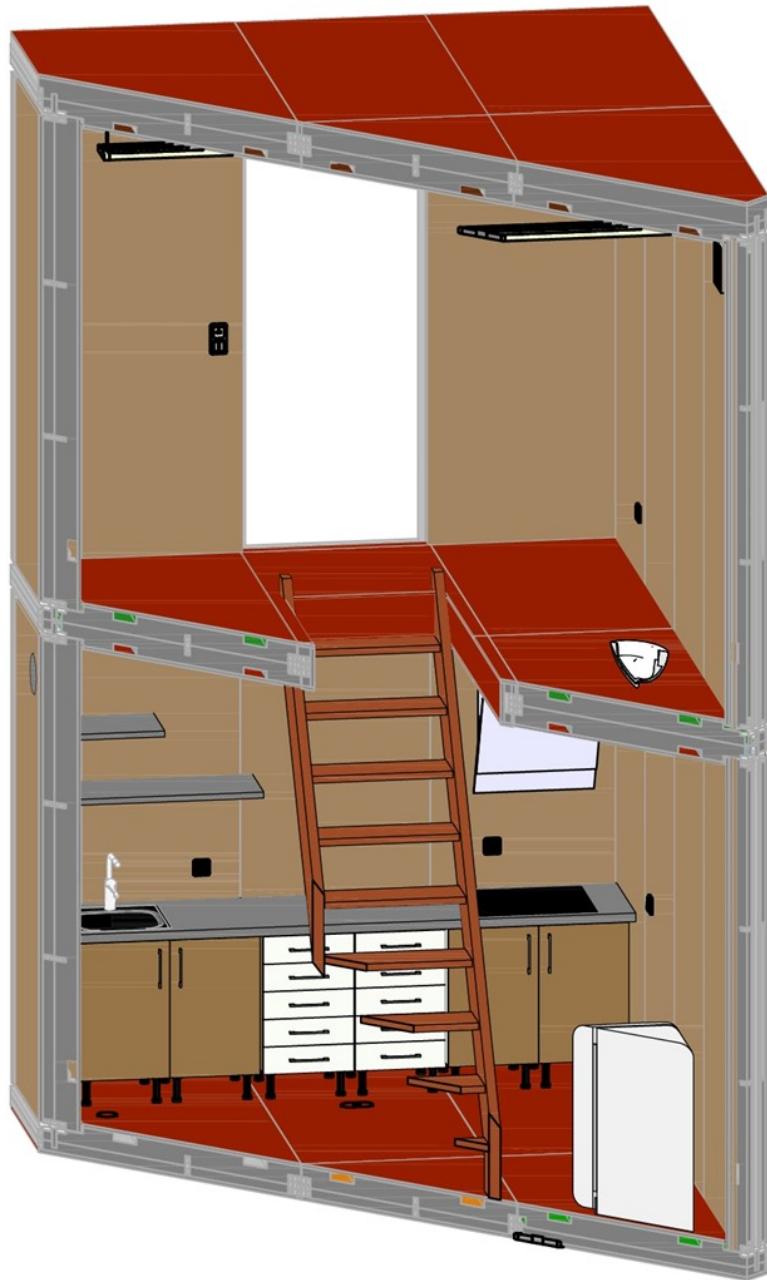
Axonometria Seccionalda Construção Piloto – Metodologia BIM
